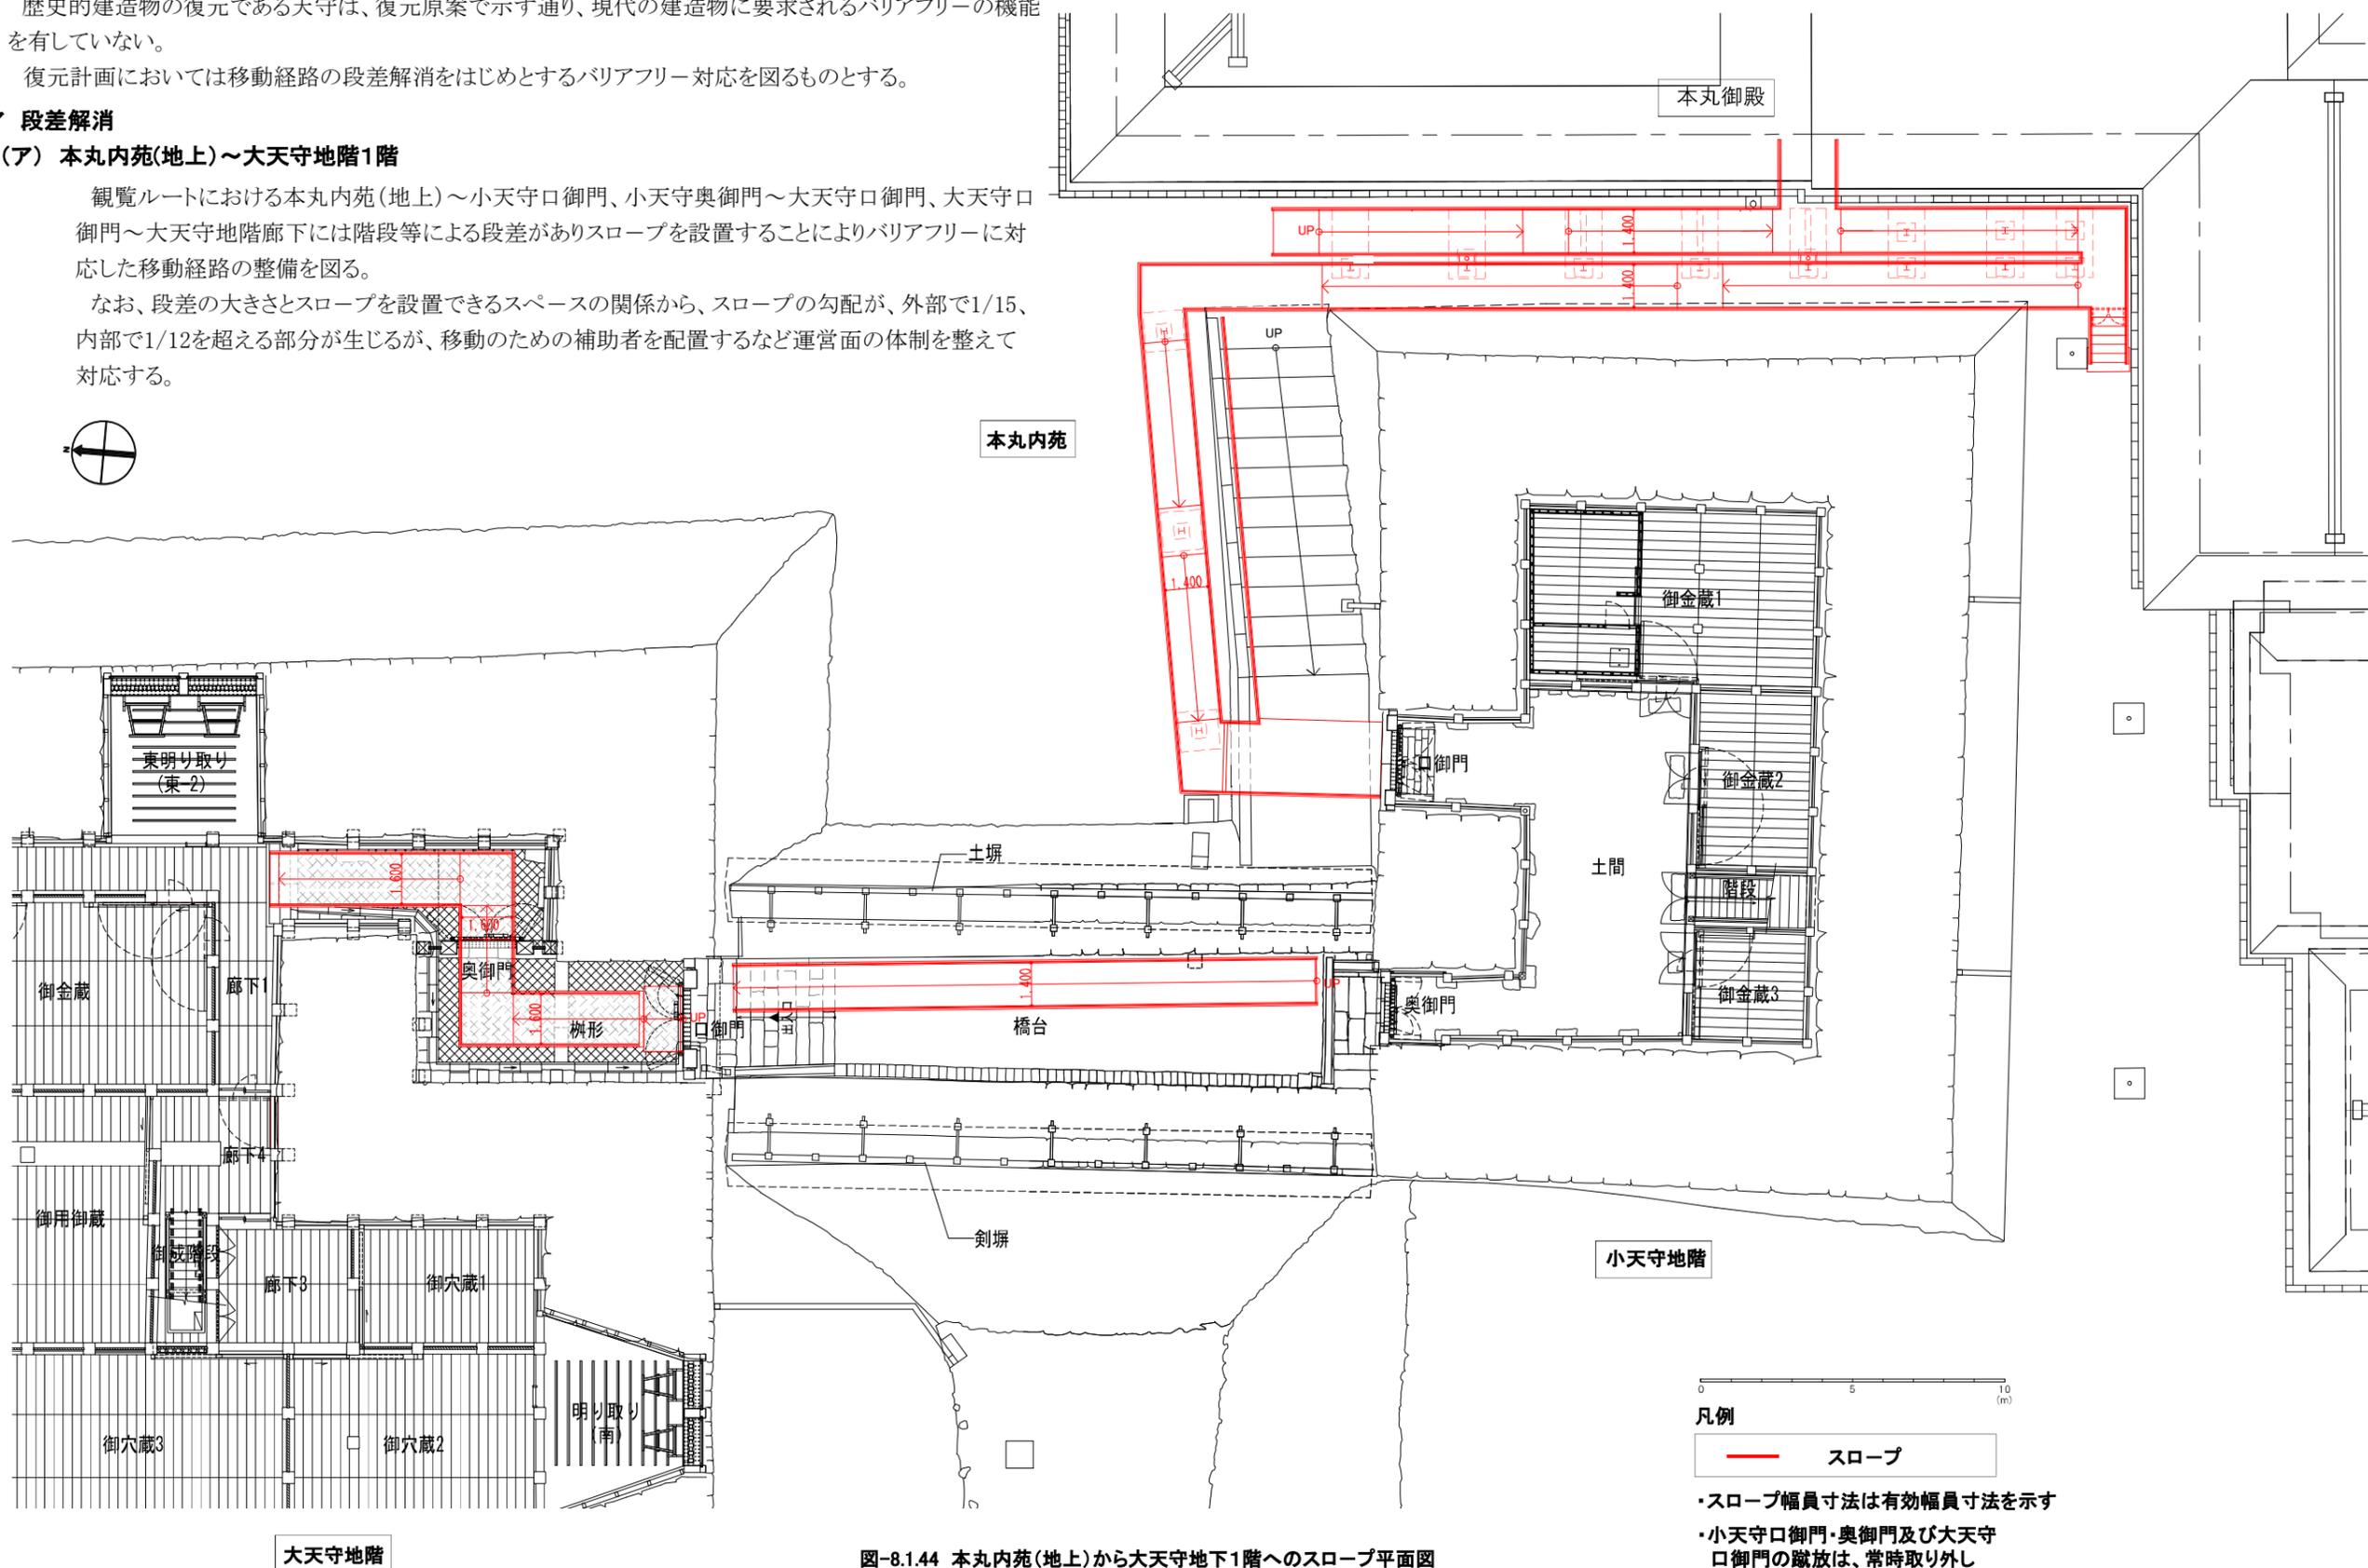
本丸内苑(地上)から大天守地下1階へのスロープ平面図
